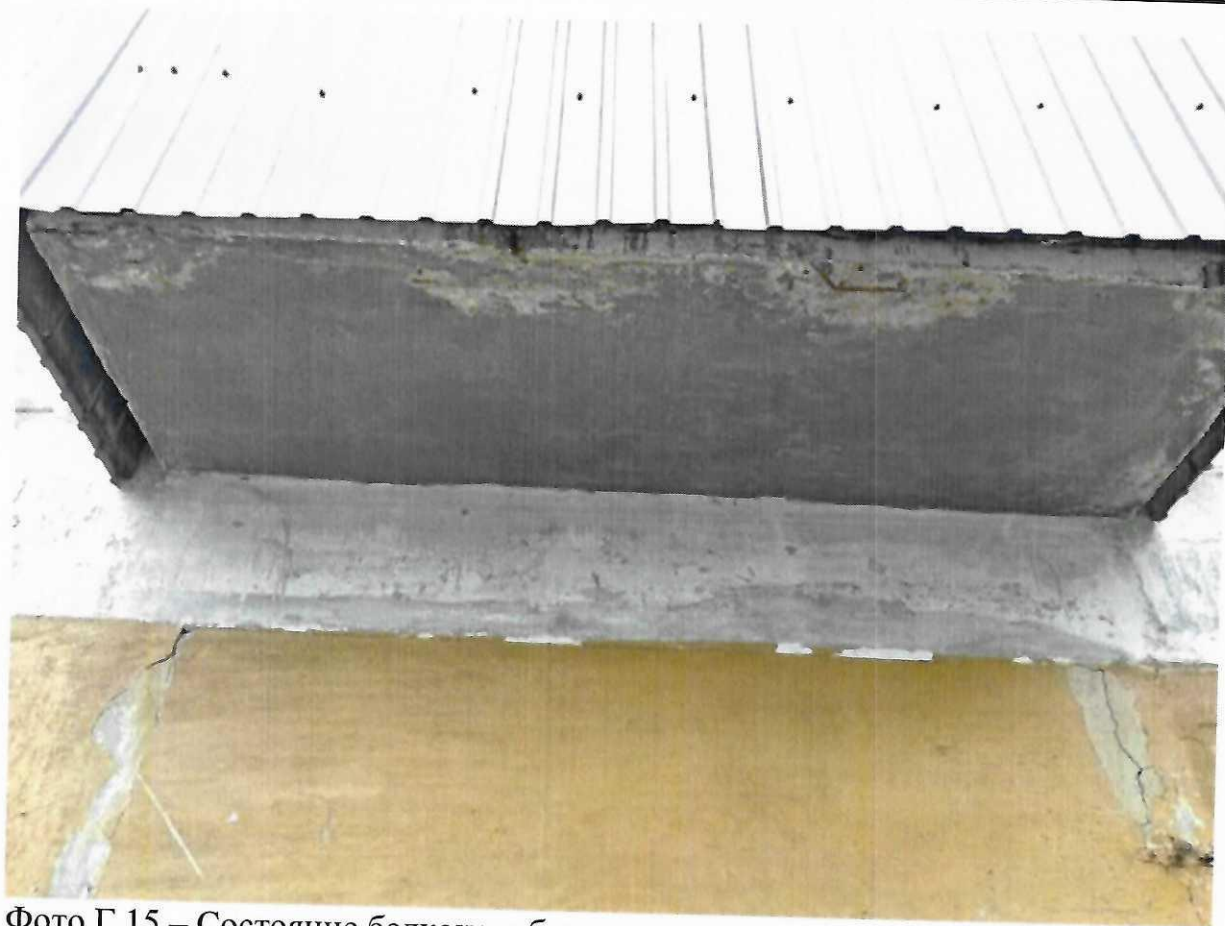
Состояние балконов: балконные плиты повреждены (разрушение защитного слоя бетона); следы затекания на поверхности бетона плиты.
